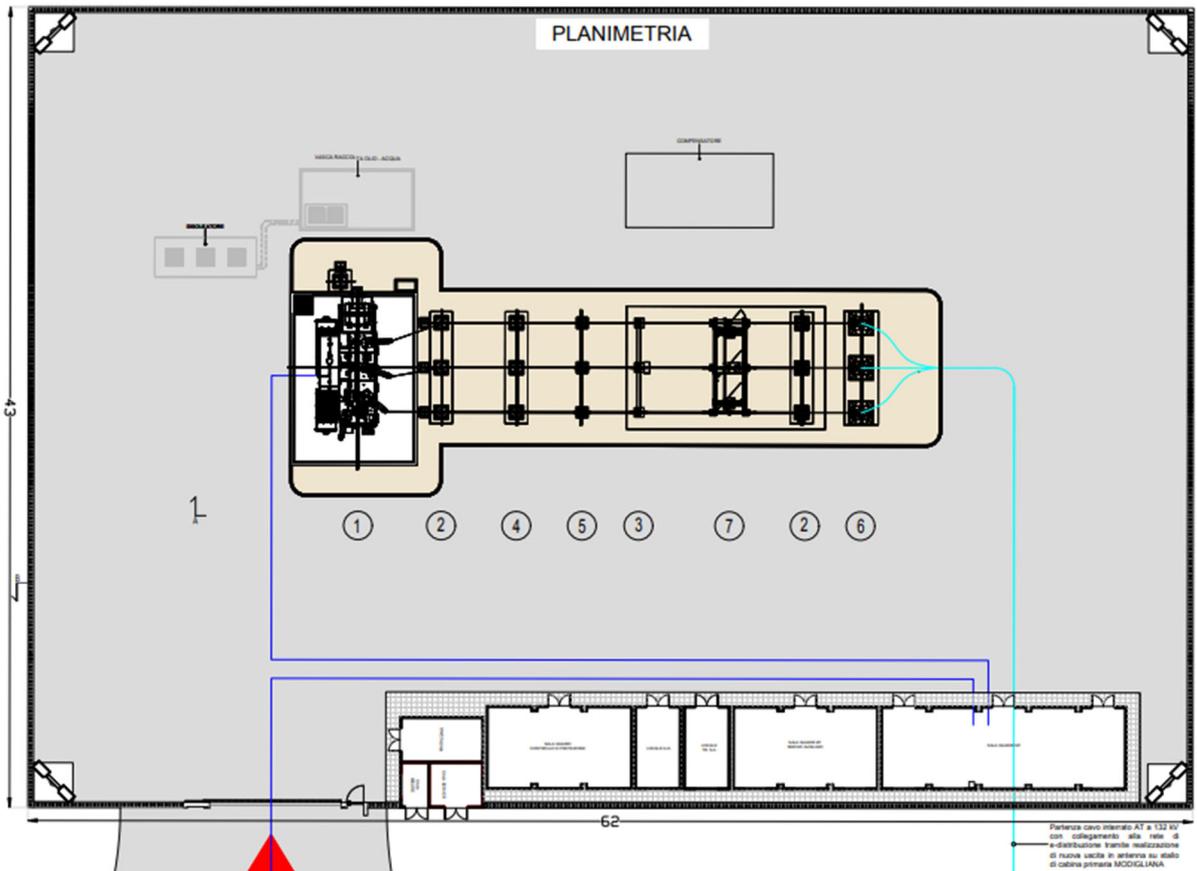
Planimetria della SSE utente di trasformazione e connessione da SMG\_T\_07\_A\_C\_A\_1
